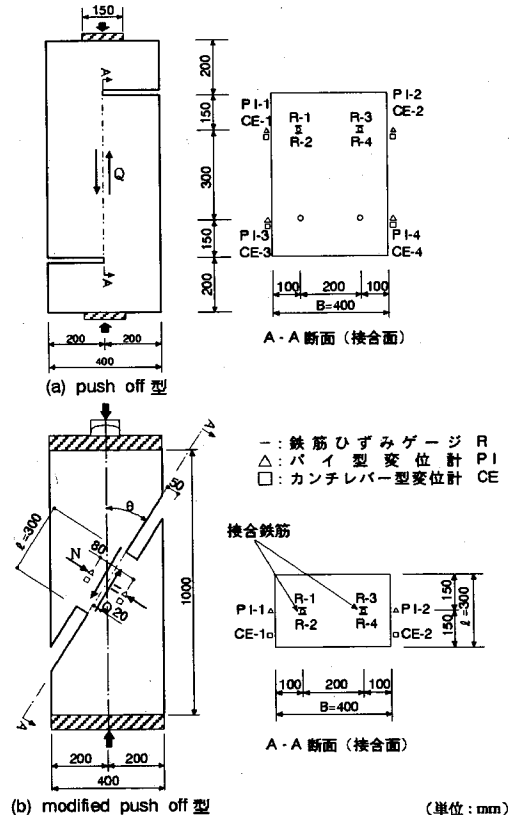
試験体寸法・載荷方法および測定位置 (単位: mm)
